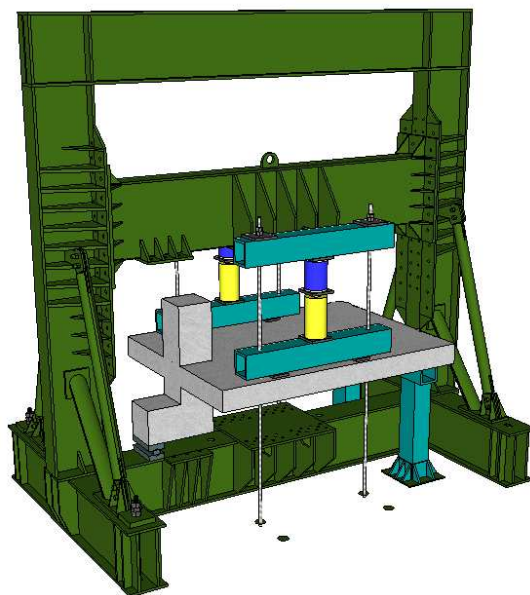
Pórtico metálico para ensaio dos modelos
